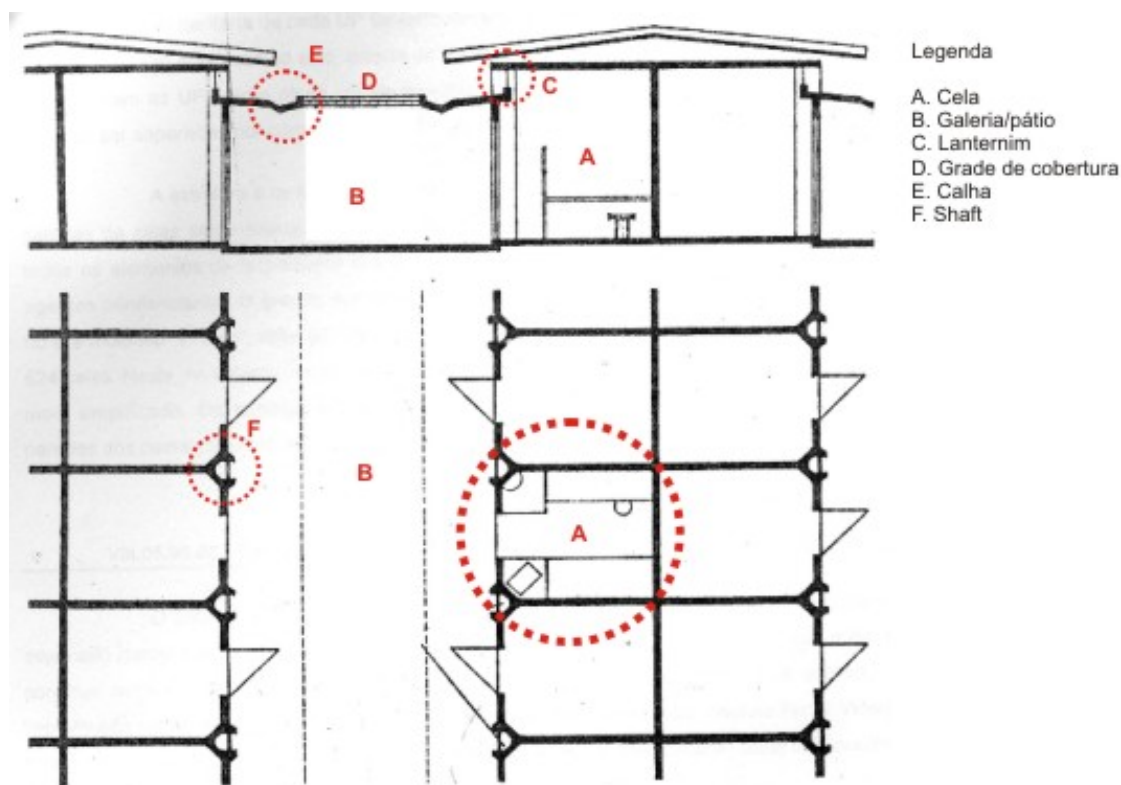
planta e corte da galeria de celas de Bangu IV
